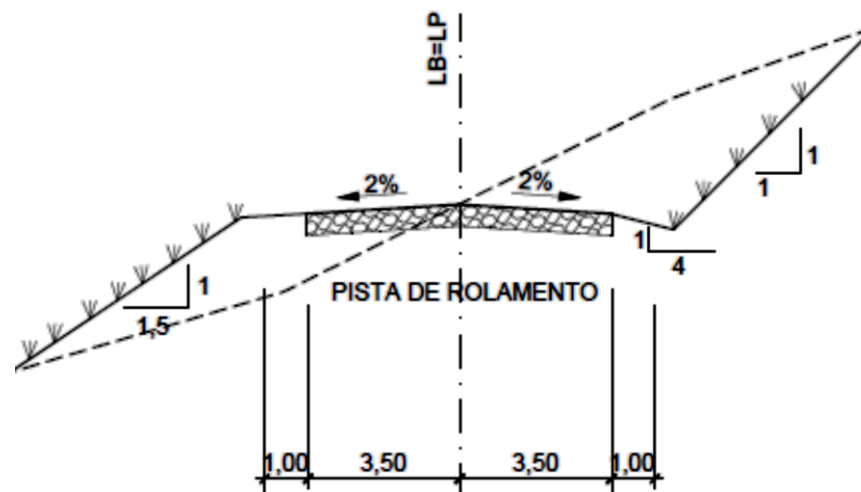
(a): Características de pista da futura Perimetral de Itatiba (extraídos da Planta DE-SPI081360-000.010-007-F01/307.R3 – Projeto Funcional – Seção Tipo).
